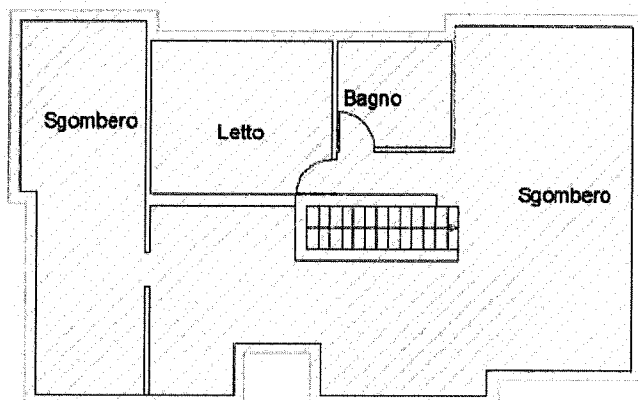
Planimetria Piano Primo – calcolo Superficie commerciale
